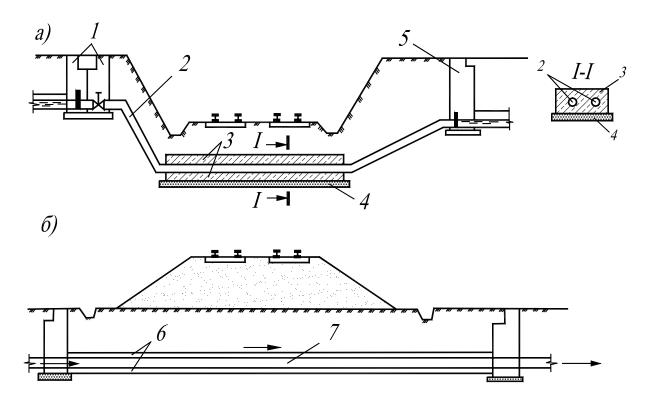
Схемы устройства пересечений водоотводящих трубопроводов с железнодорожными путями уложенными:
